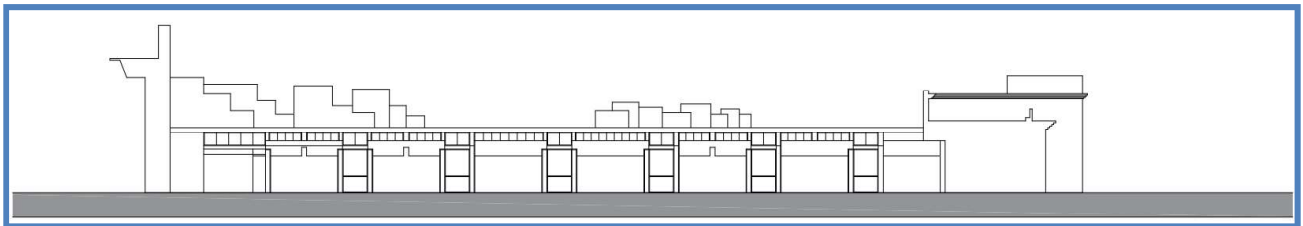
fabbricato stufe – PROSPETTO NORD-EST
